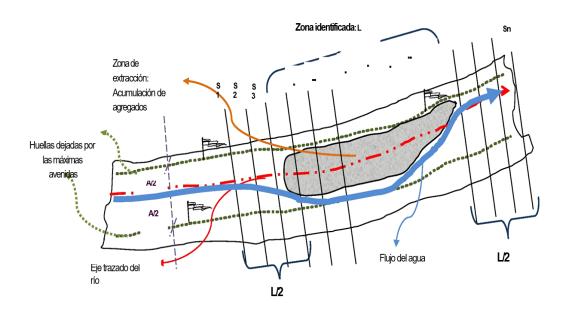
Vista de planta de un río, en donde se ha trazado el eje del río y las secciones transversales
